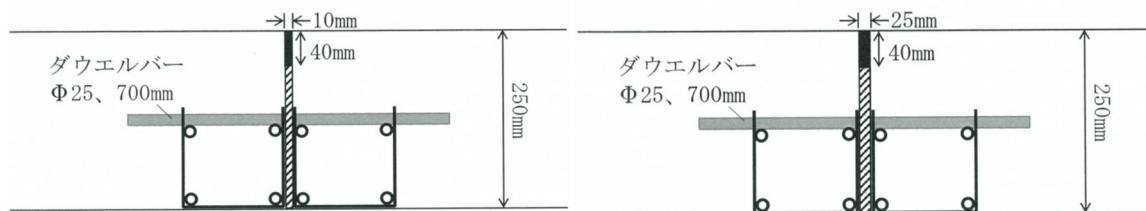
施工断面図 (左：収縮目地 右：膨張目地)
